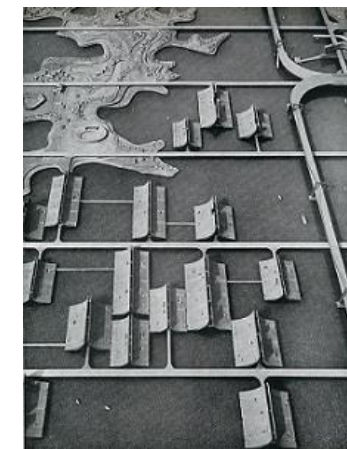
Plan para la reordenación y ampliación de Tokio. La zona residencial con la autopista y las zonas residenciales.
